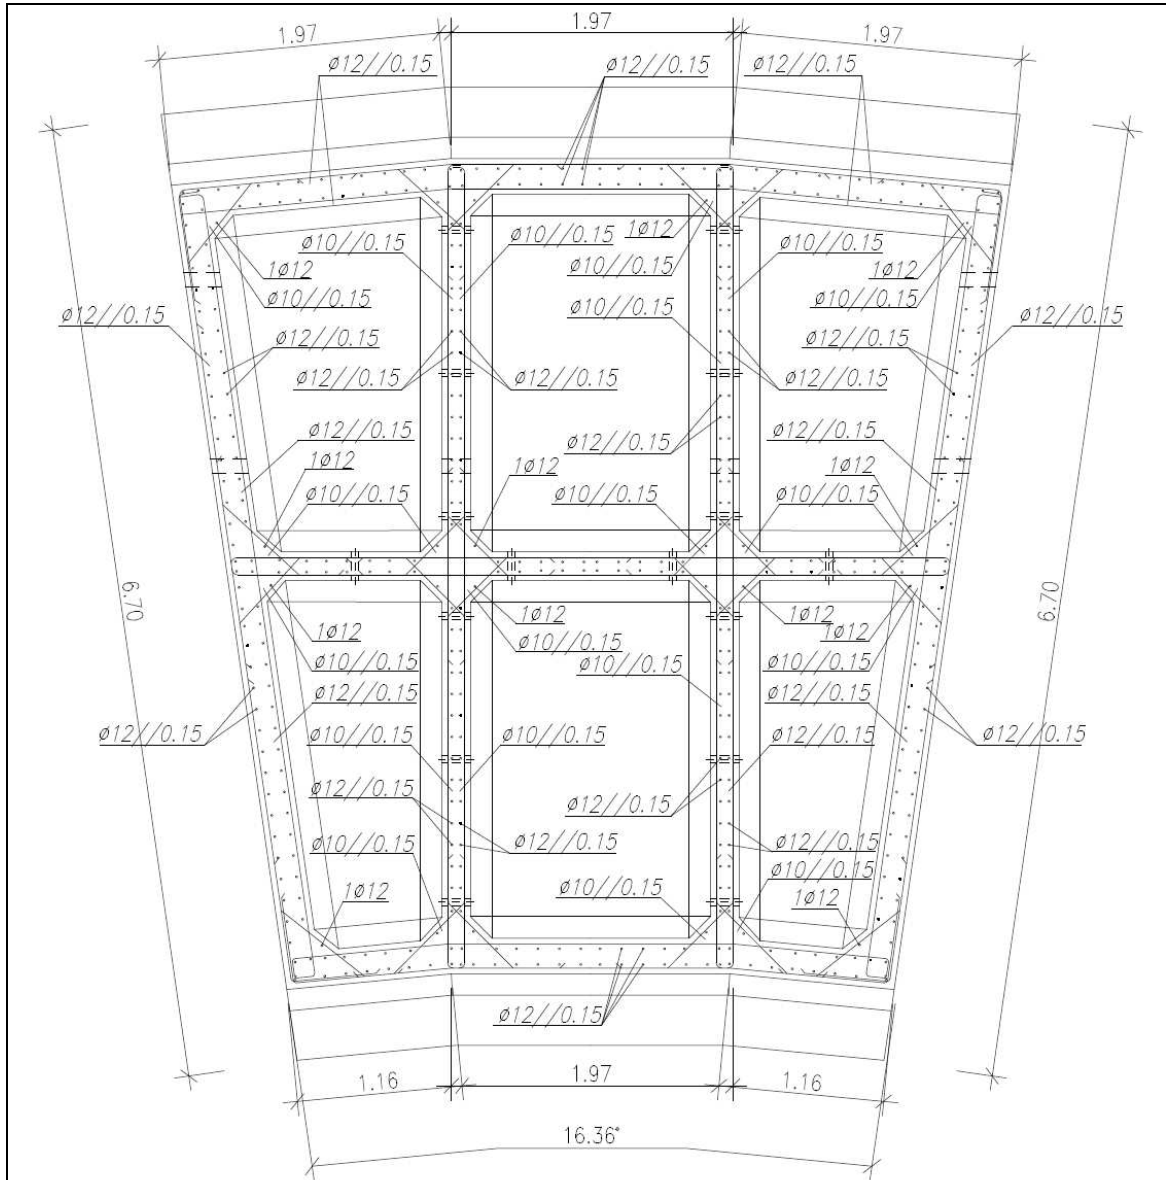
Corte construtivo horizontal das aduelas do tipo A6 (imagem do projecto de execução).
